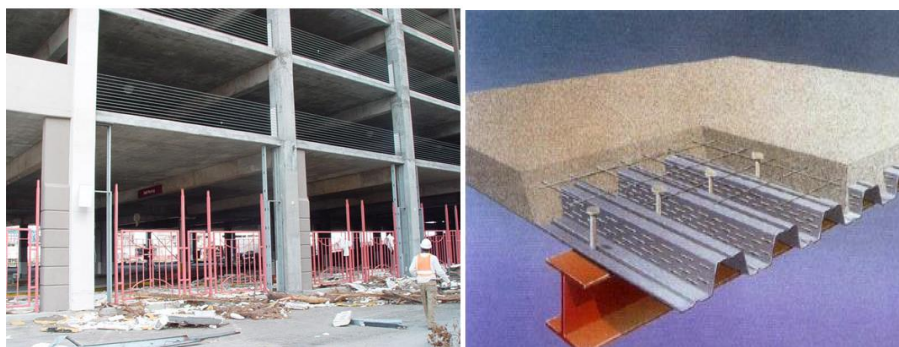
Exemplo de construção em betão armado e com estruturas mistas (Engibarra, 2015 e Guimarães, 2009)
